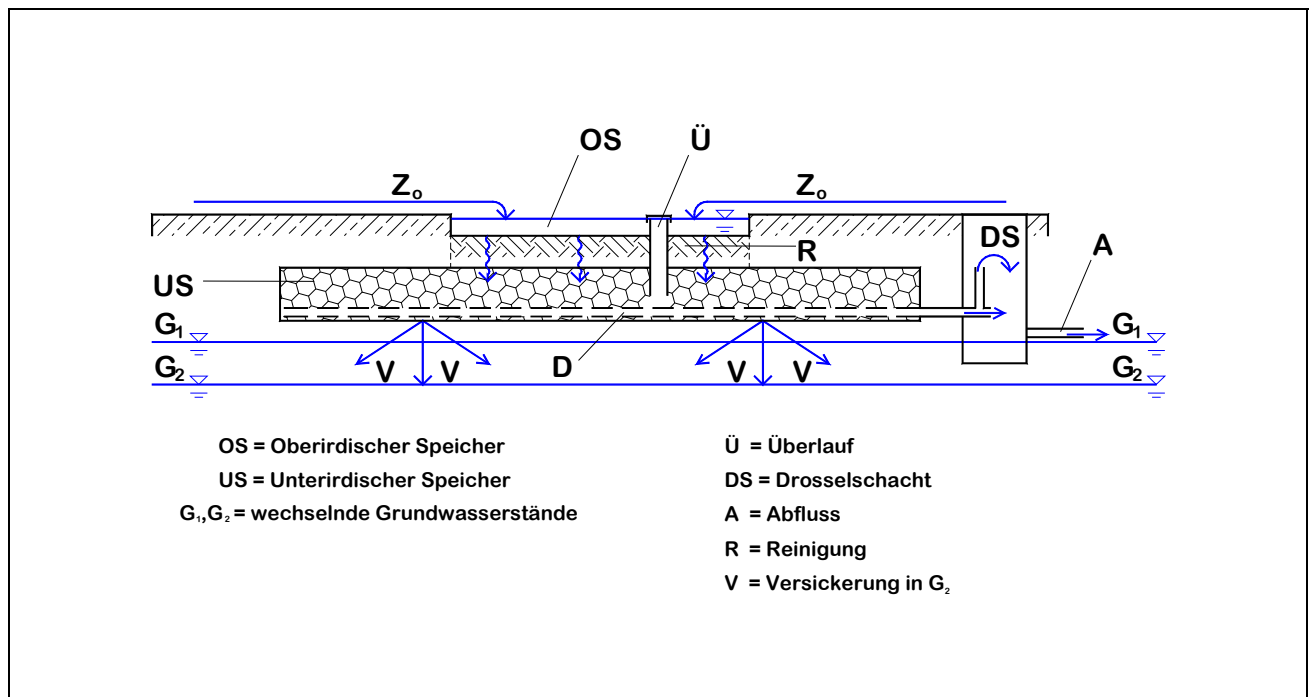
Variante III - Kombinierte Oberflächen- und Untergrundspeicherung mit regelbarem Ablauf
